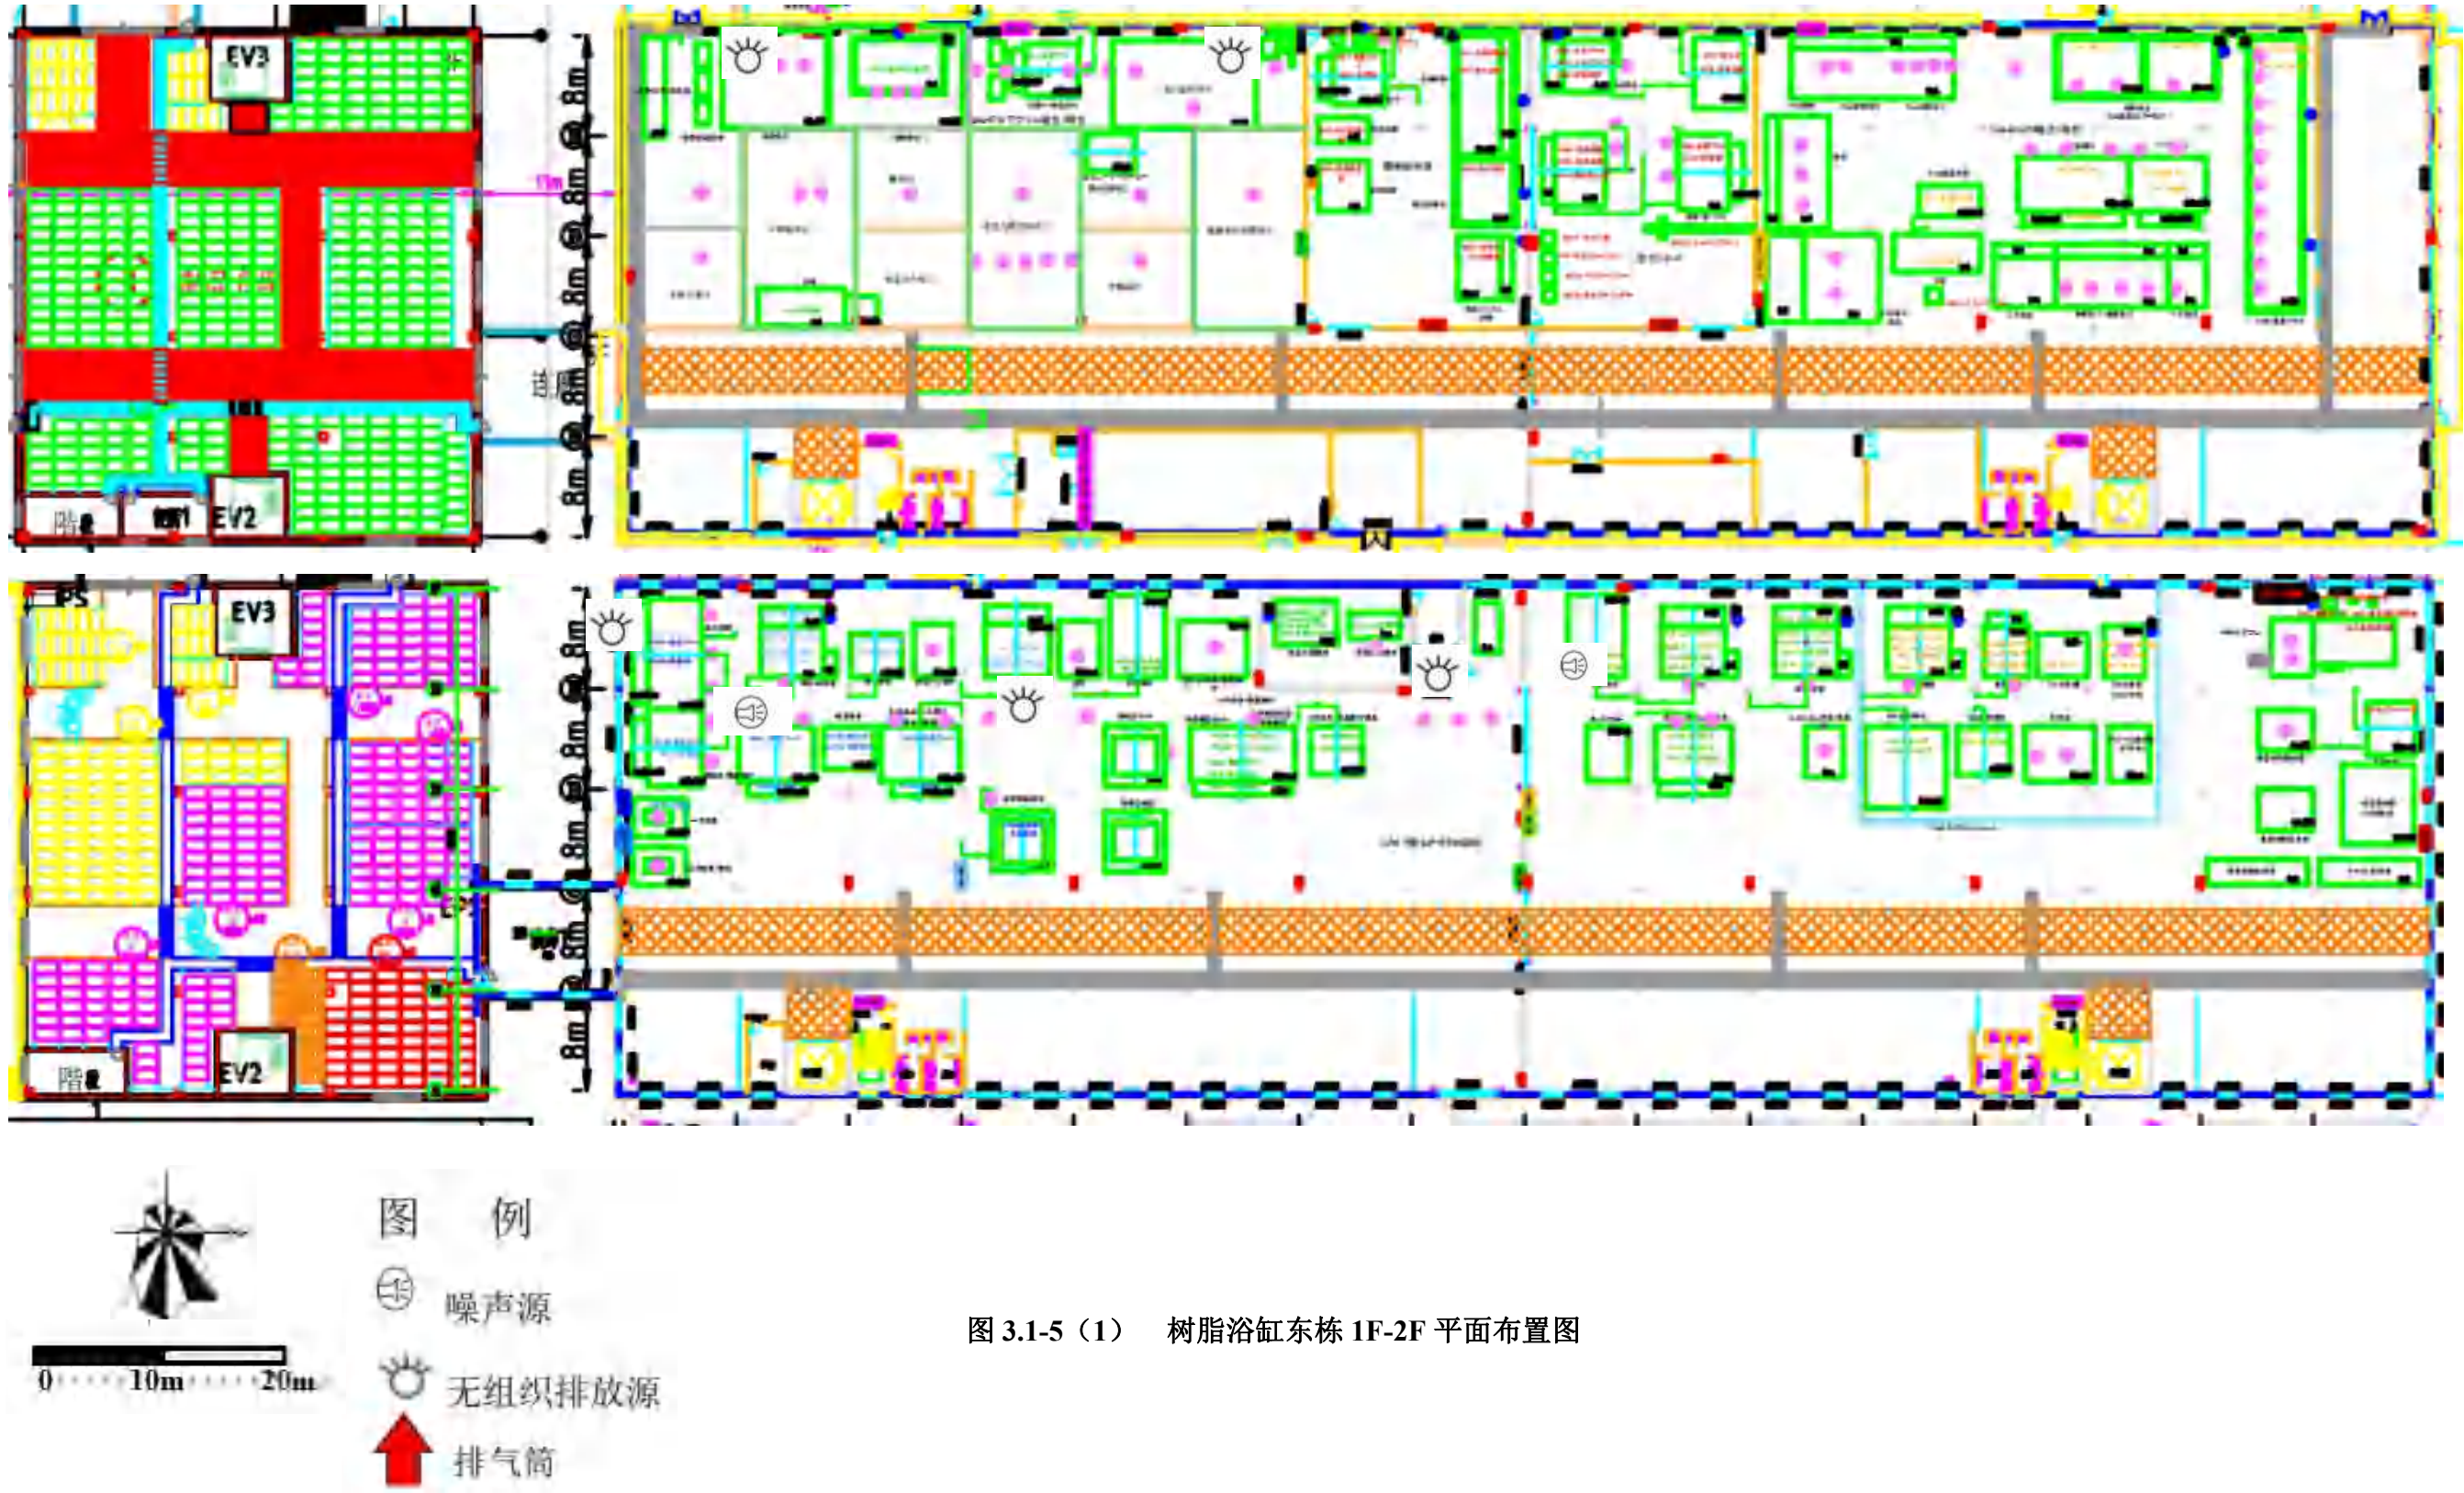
(1) 树脂浴缸东栋 1F-2F 平面布置图
